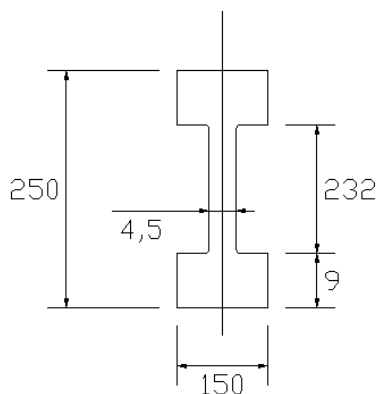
Dimensiones del Perfil de las columnas
